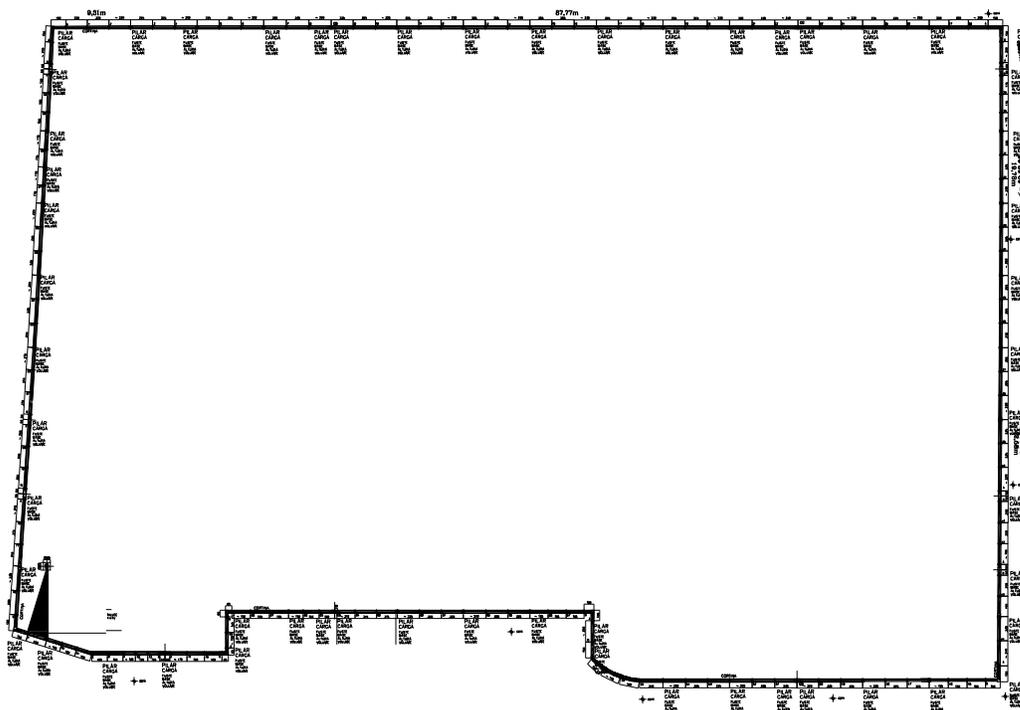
Planta de fundações com o perímetro de cravação das estaca.
